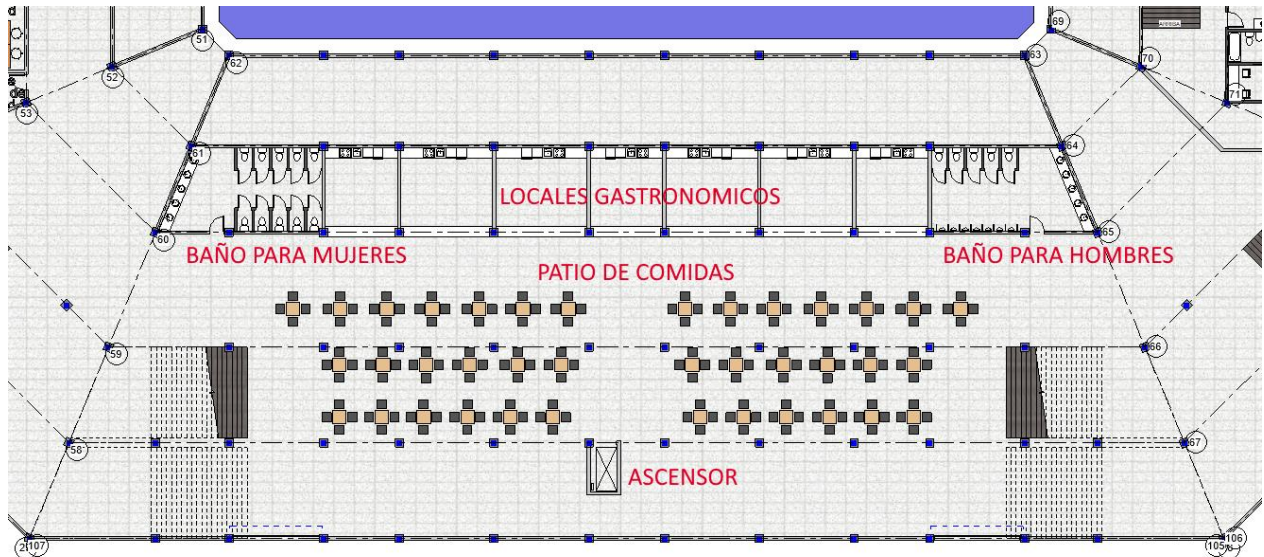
Vista en planta del sector sur. Fuente: elaboración propia
